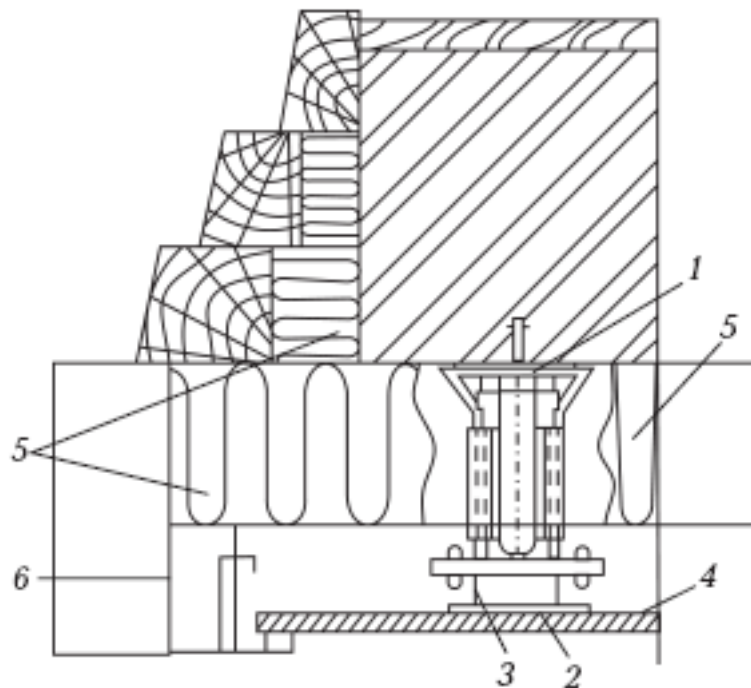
Узел примыкания навесной фасадной системы к оконному проему: 1 – кронштейн; 2 – направляющая; 3 – кляммер; 4 – плитка облицовочная; 5 – плита теплоизоляционная; 6 – стальной элемент рамы оконного обрамления
